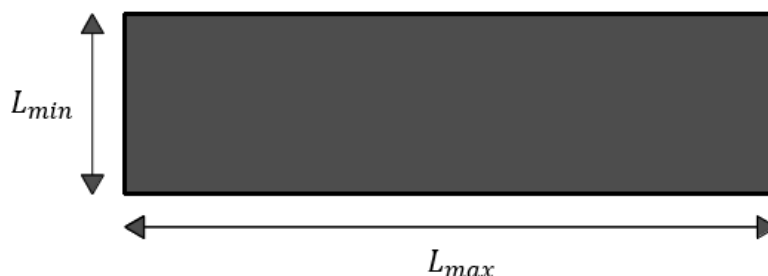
Dimensões máximas e mínimas em planta do edifício
